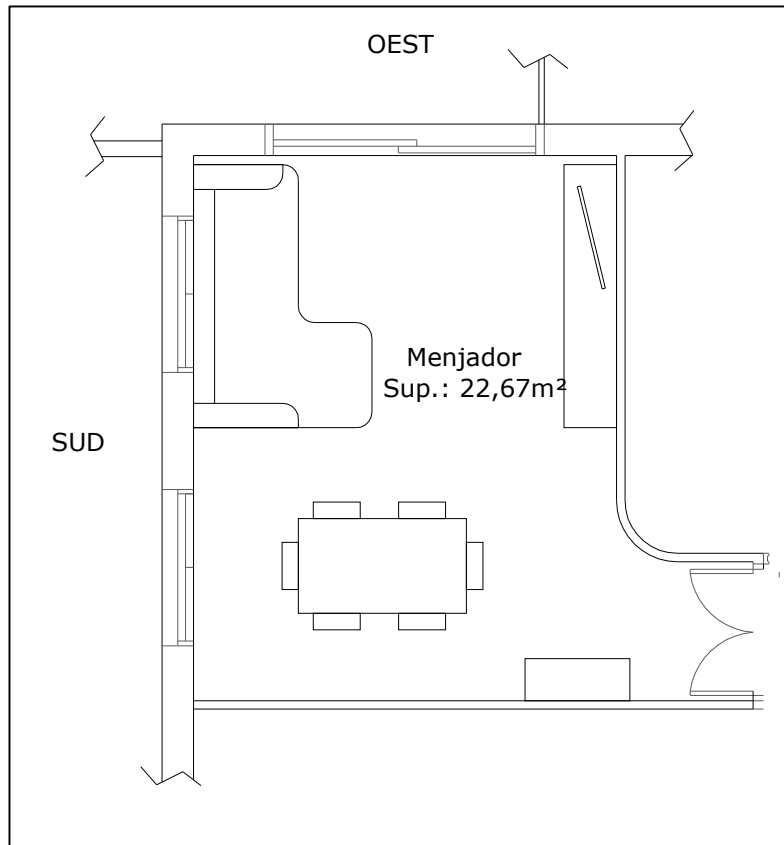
Gràfic que mostra la vista en planta del menjador i la seva orientació
